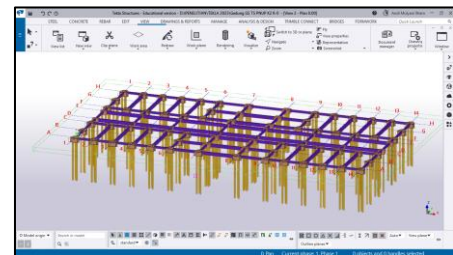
Layout Lantai 2 Gedung Sekolah Teknik Sipil Kampus 2 PNUP
